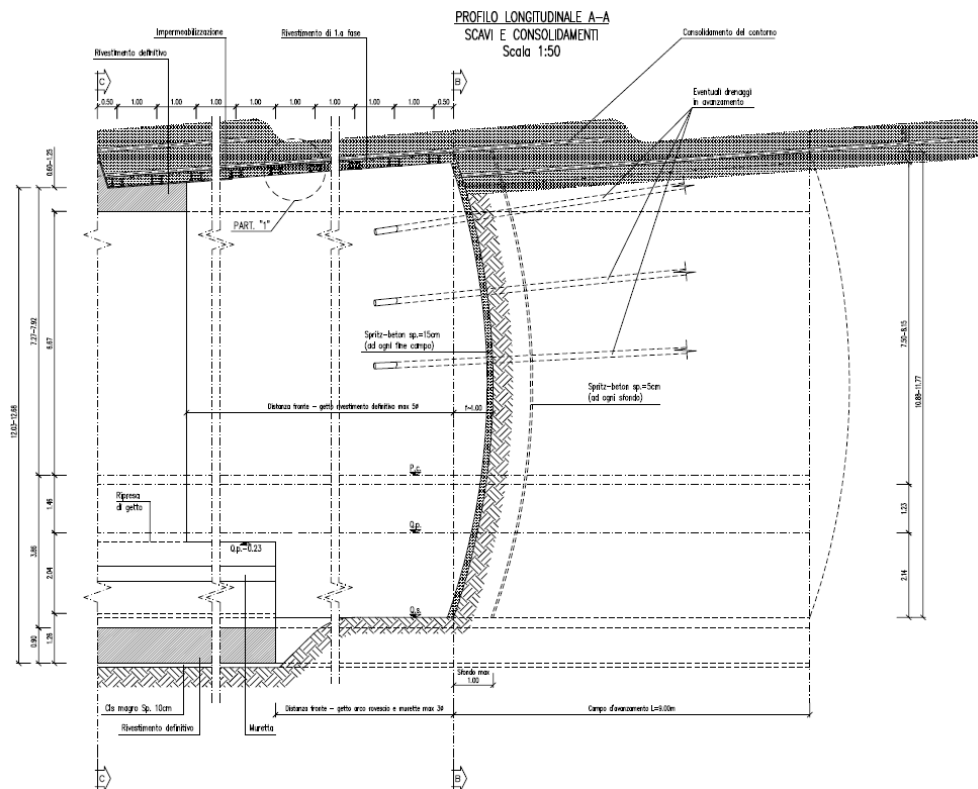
Sezione tipo B0V (profilo longitudinale)
